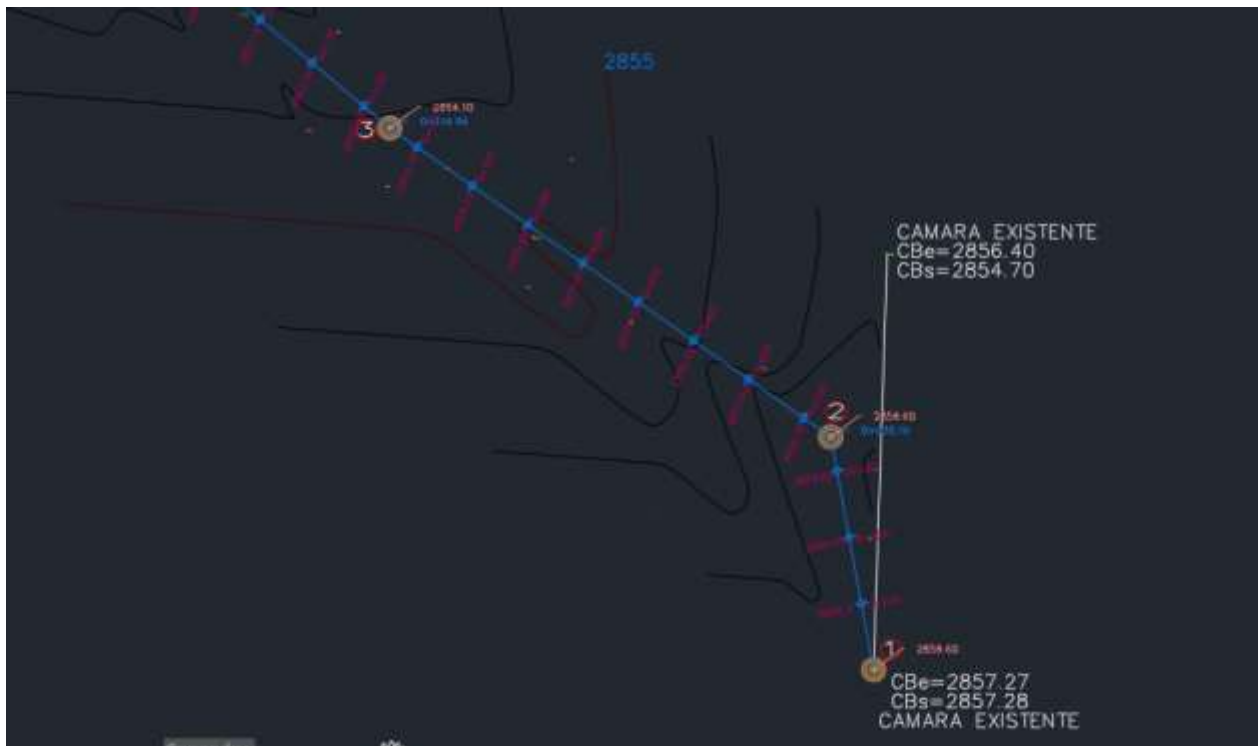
Cámaras existentes y nueva conexión alcantarillado tramo 1, 2 y 3.
